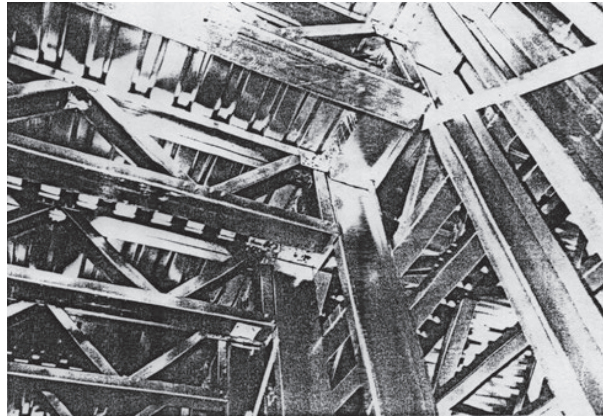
Перекрытия третьего этажа из тонкостенных стальных конструкций
